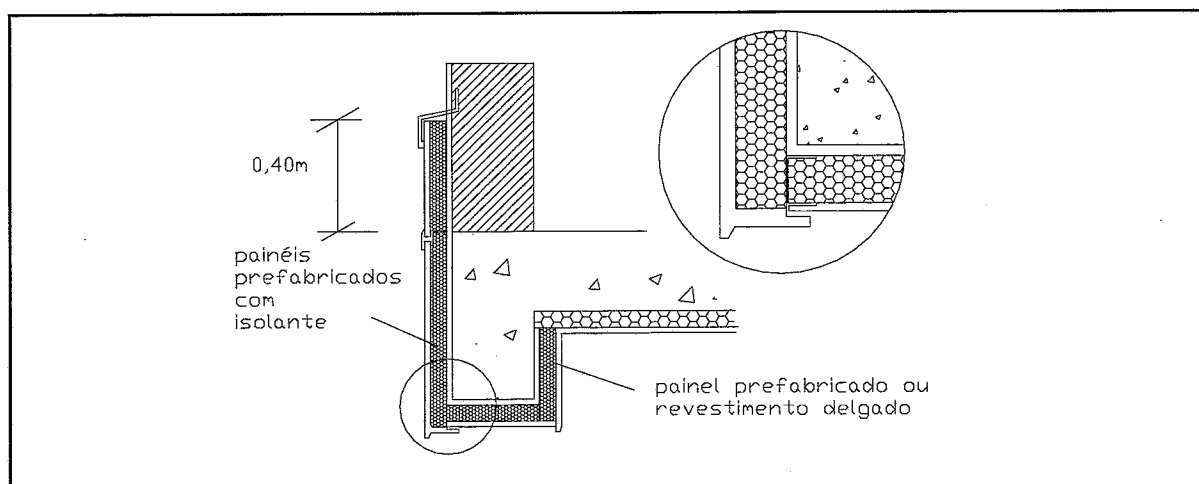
Pormenor de correcção térmica na laje com painéis prefabricados isolante/revestimento
